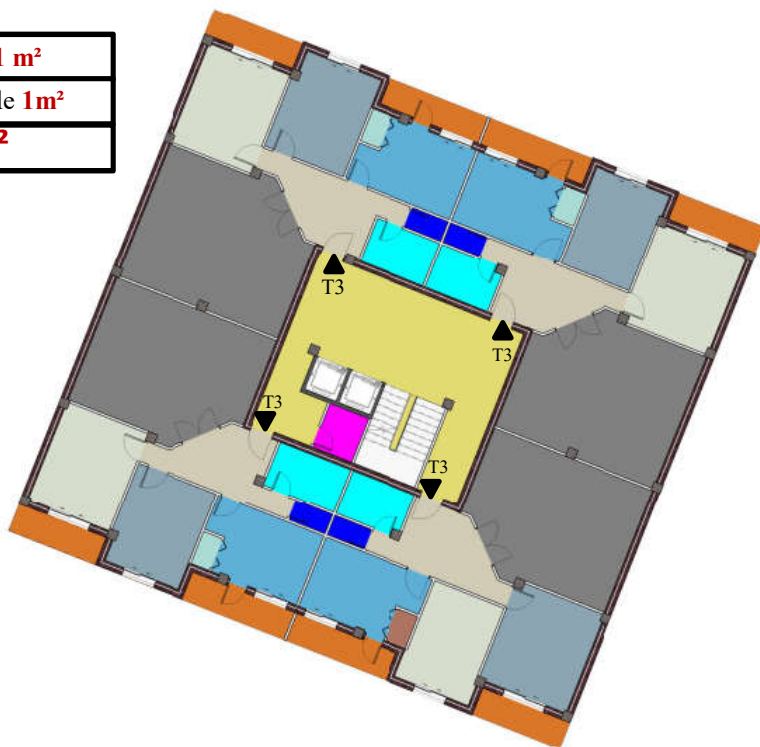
Vue en plan –Bloc Toure Plan 1 étage
